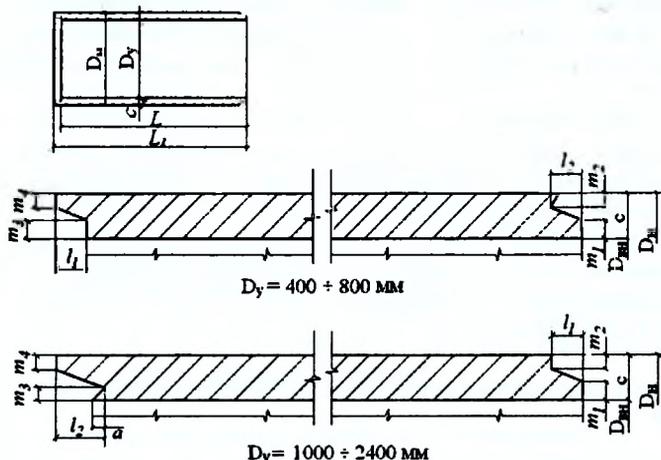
Общий вид труб фальцевых цилиндрических типа ФТ по ГОСТ 6482.0-79
